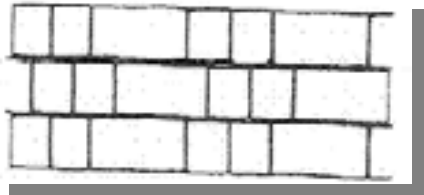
Maison individuelle en béton armé (préfabriqué) (Source : CETE Méditerranée)
